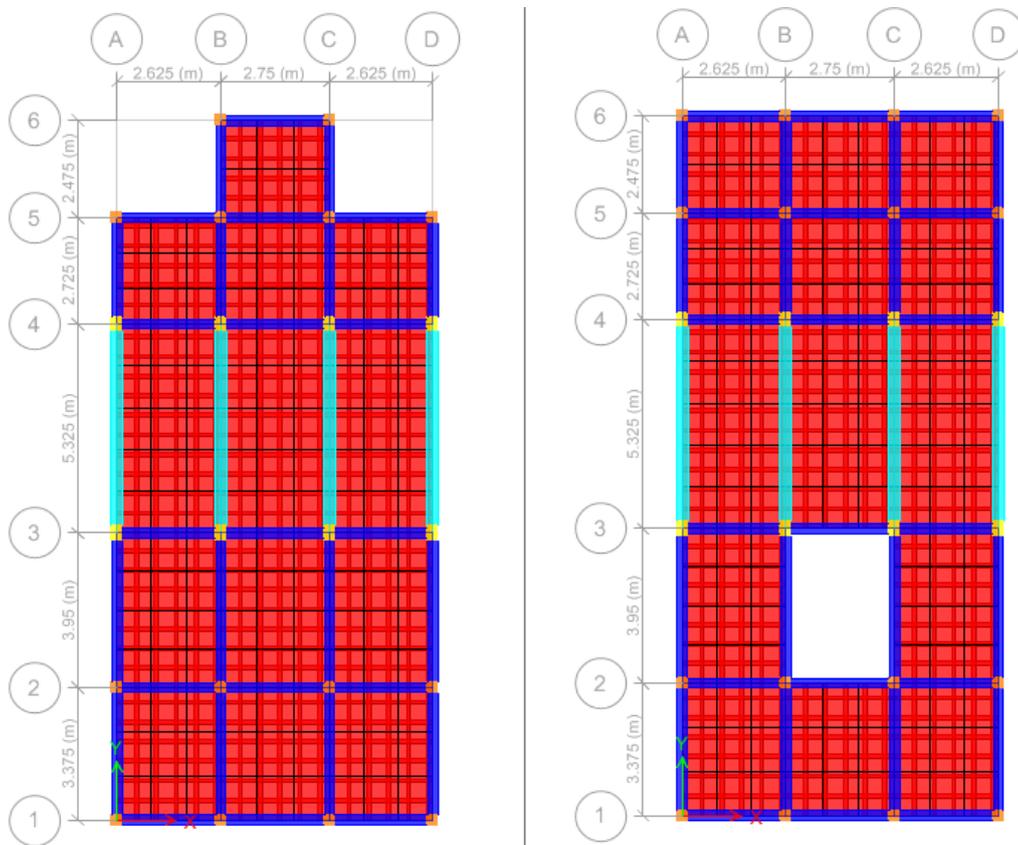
Vista en planta de la planta baja (imagen derecha) y cubierta (imagen izquierda)
